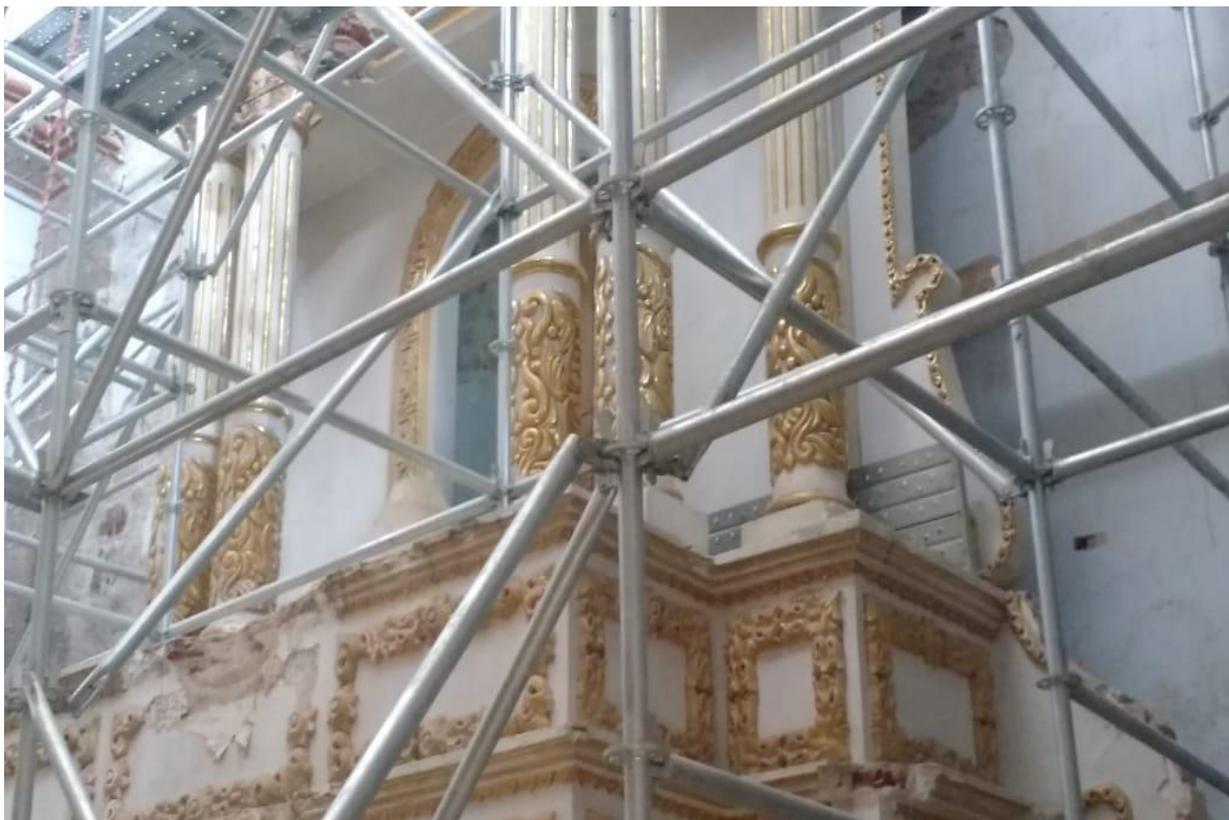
Andamiaje para reestructuración de la cúpula del ábside, 2018. Foto. Laura Moyers Ruíz.
